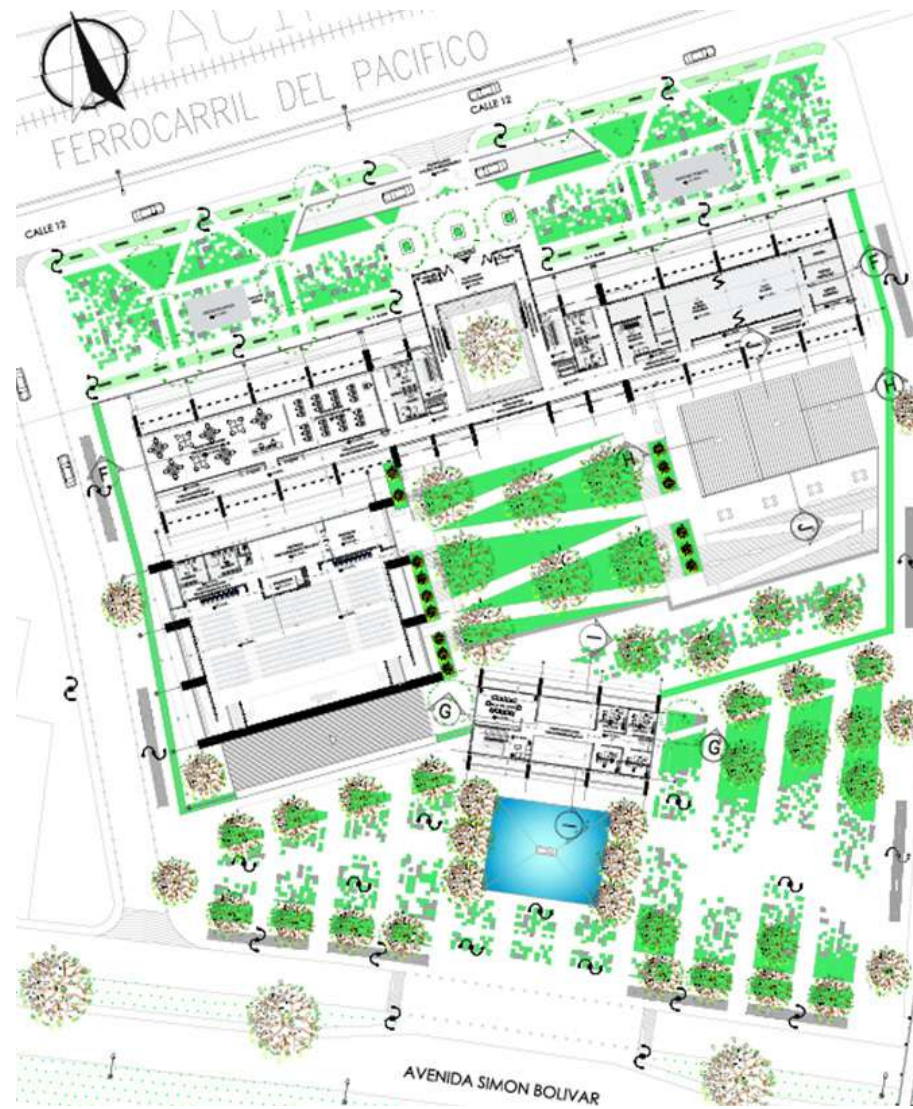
planta arquitectónica 2° piso. Fuente: elaboración propia.
